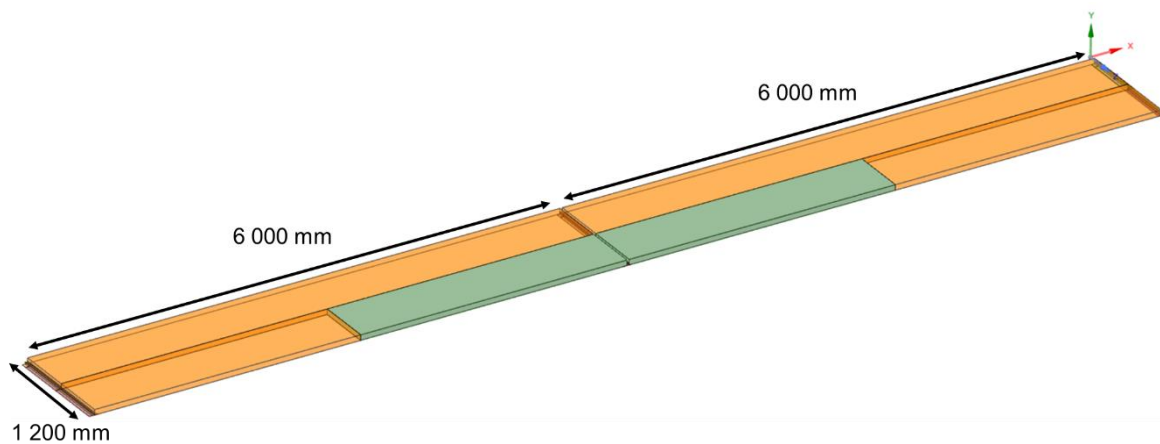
Représentation de la structure globale avec les dalles de faux plafonds entières et les profilés entiers
